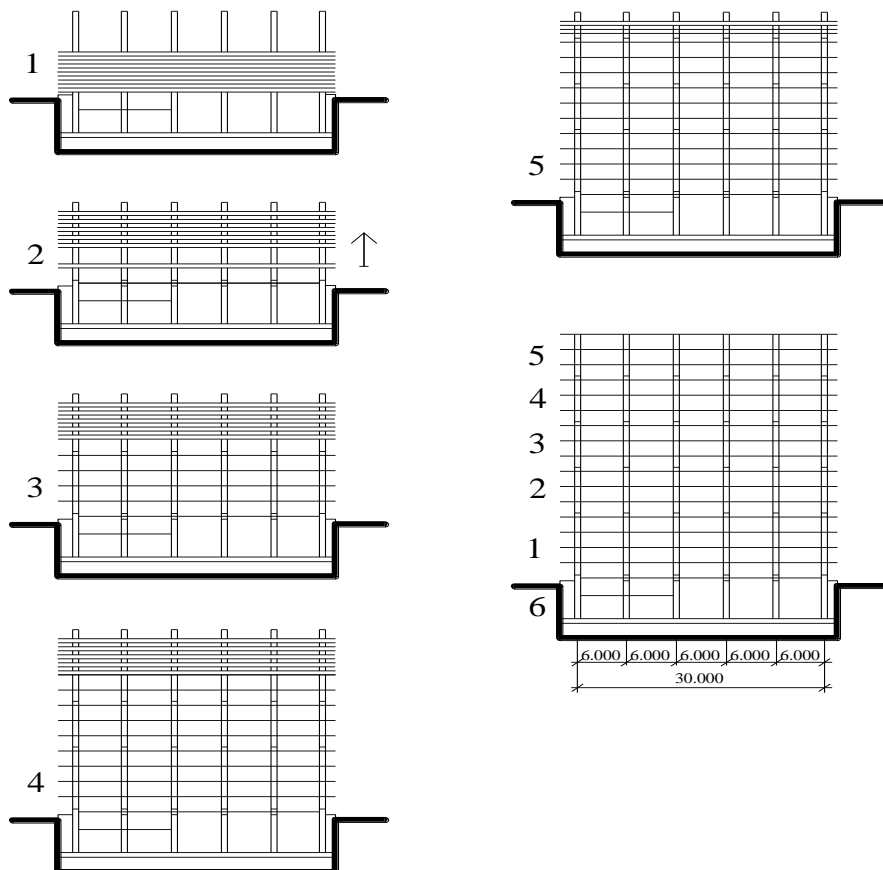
Схема монтажу будинку методом підйому перекриттів:
